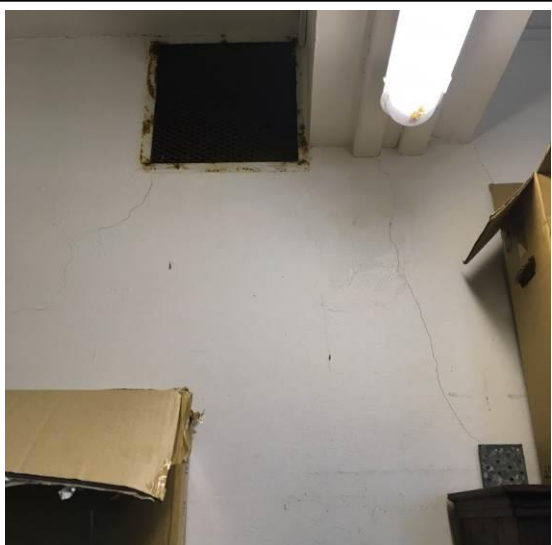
Bâtiment A RDC, réserve salle TP2 - Paroi verticale : D2 - Fissuration modérée.
